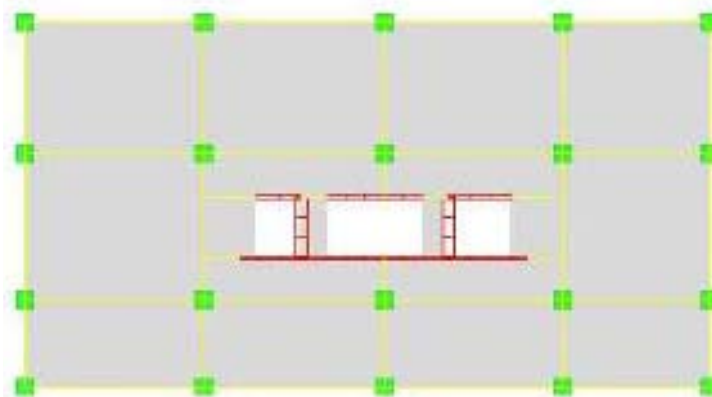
Planta Piso Tipo Edificio de Marcos
